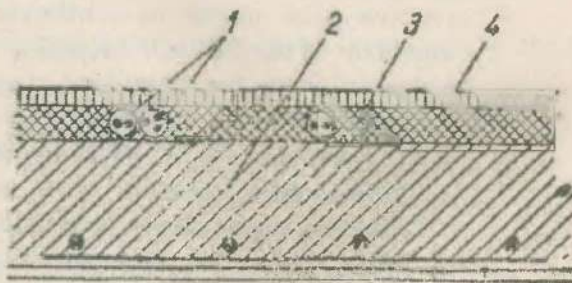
Montarea tuburilor peste placa de beton armat :
